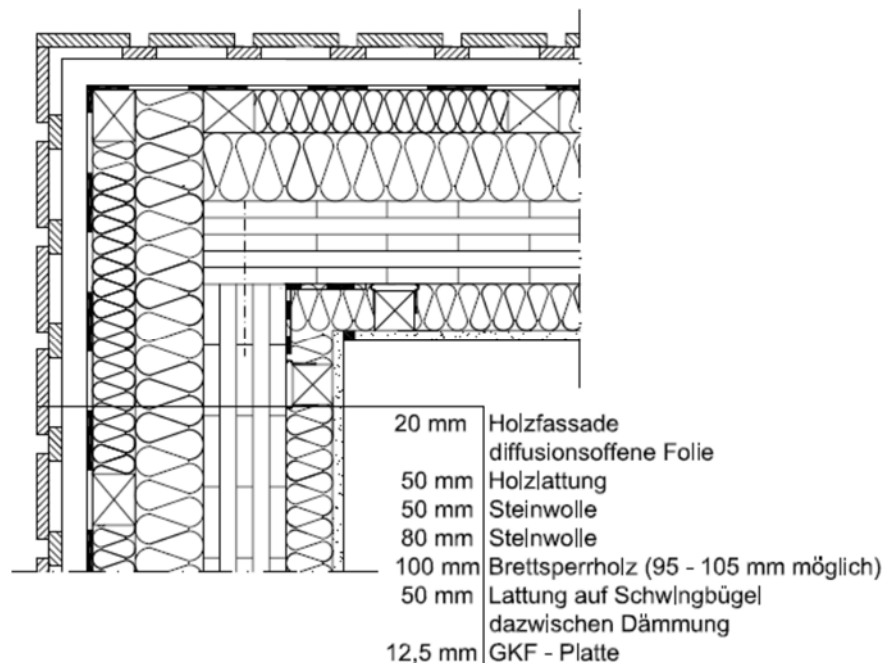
Beispielhafte Ausführung Außenwanddecke mit Installationsebene
